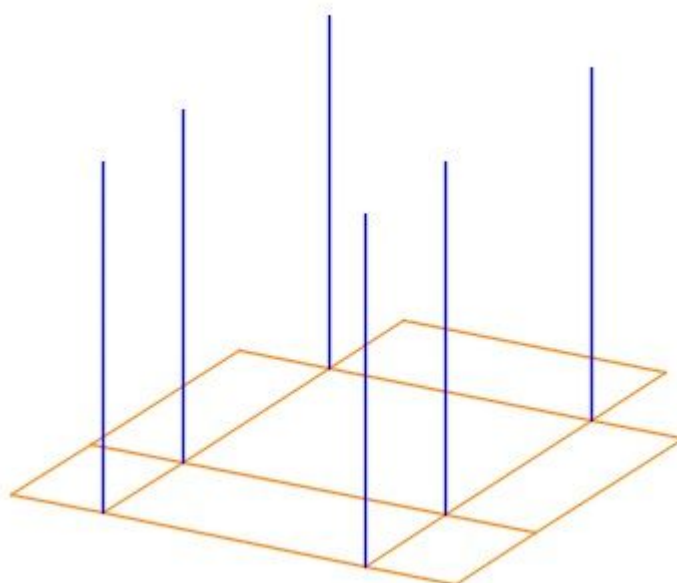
Proyección en planta de la estructura y representación de aristas de pilastras.
